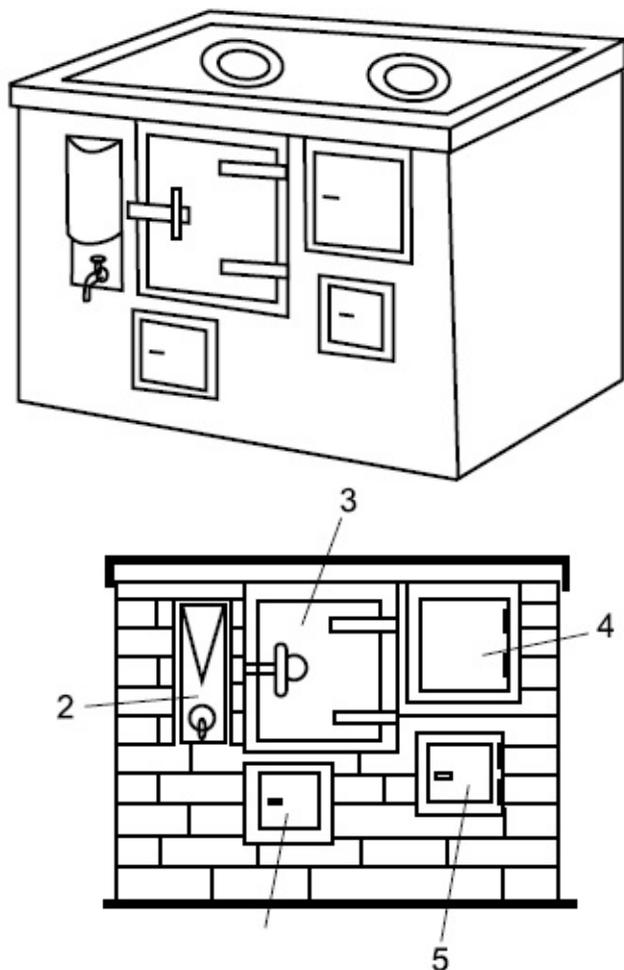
Кухонная плита с духовкой и водогрейной коробкой: 1 – чистка; 2 – водогрейная коробка; 3 – духовка; 4 – топливник; 5 – поддувало
